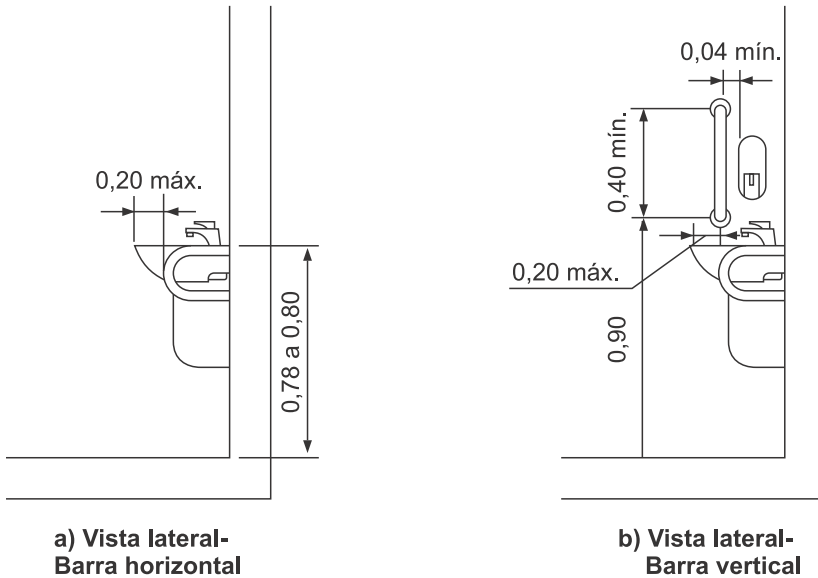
Barra de apoio no lavatório – Vista lateral
